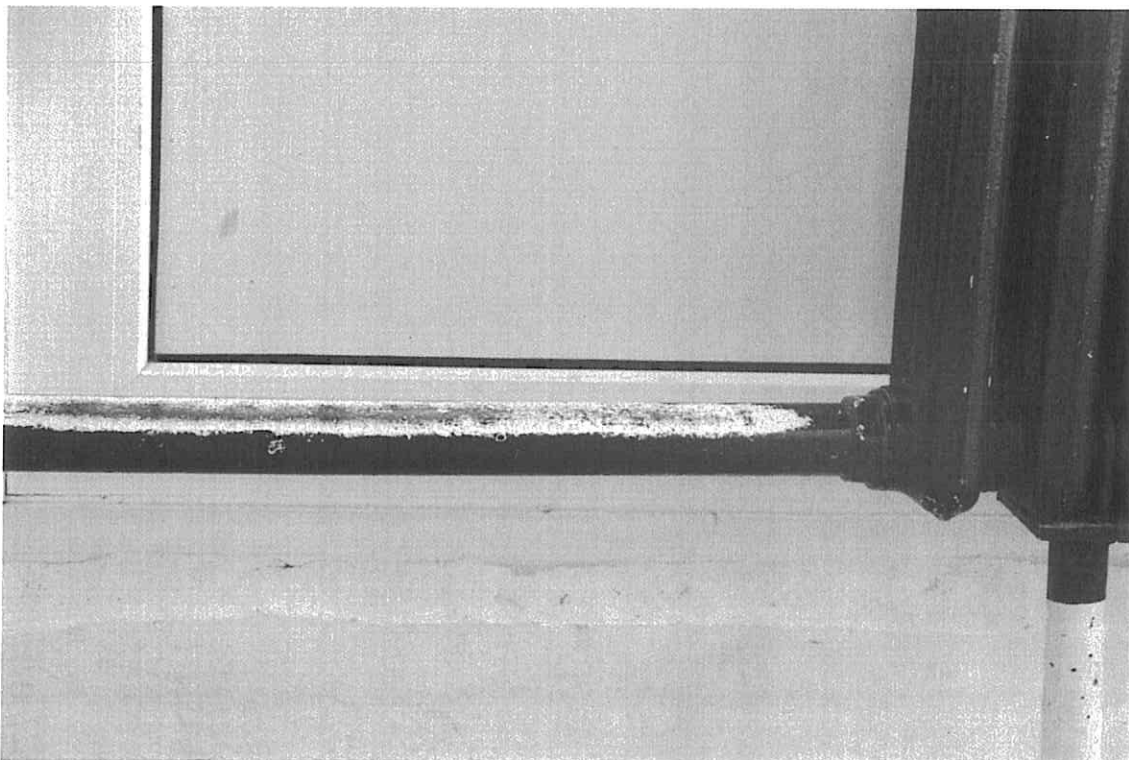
Farbabblätterung Wasserschaden, Dichtung
